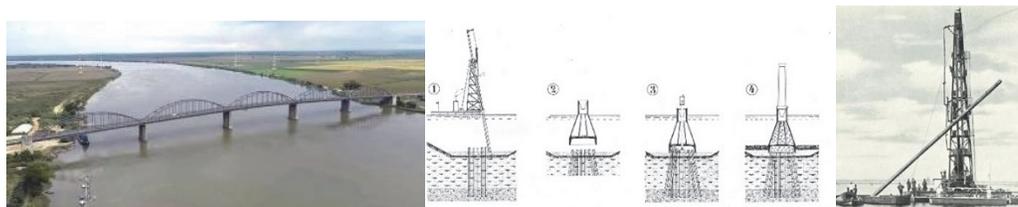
Vista de jusante da Ponte Marechal Carmona e metodologia construtiva das fundações.
